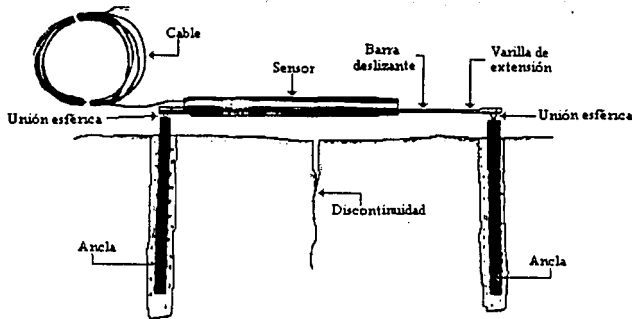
Medidor de grieta eléctrico.
